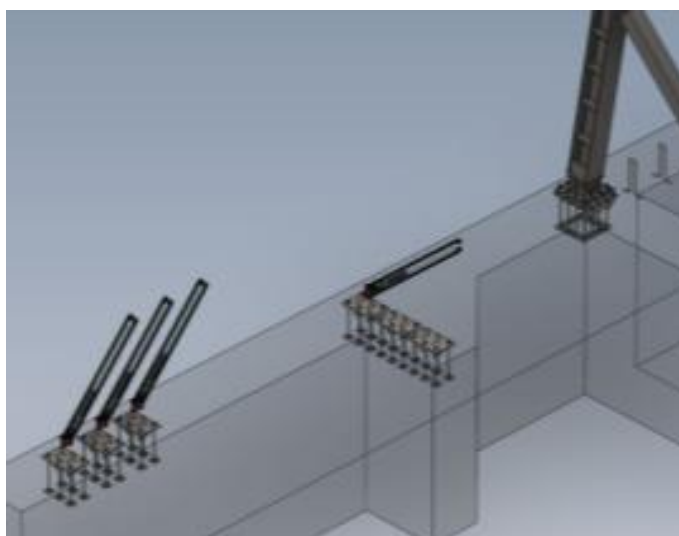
Крепление стоек селеудерживающего барьера к основанию
